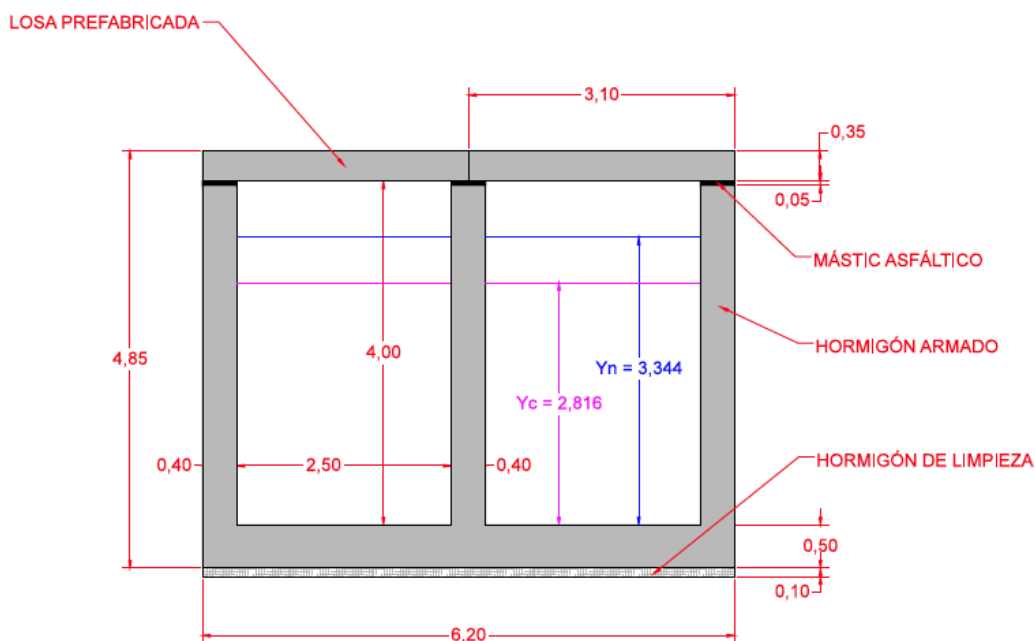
Sección estándar (cotas en metros). FUENTE: Elaboración propia.
